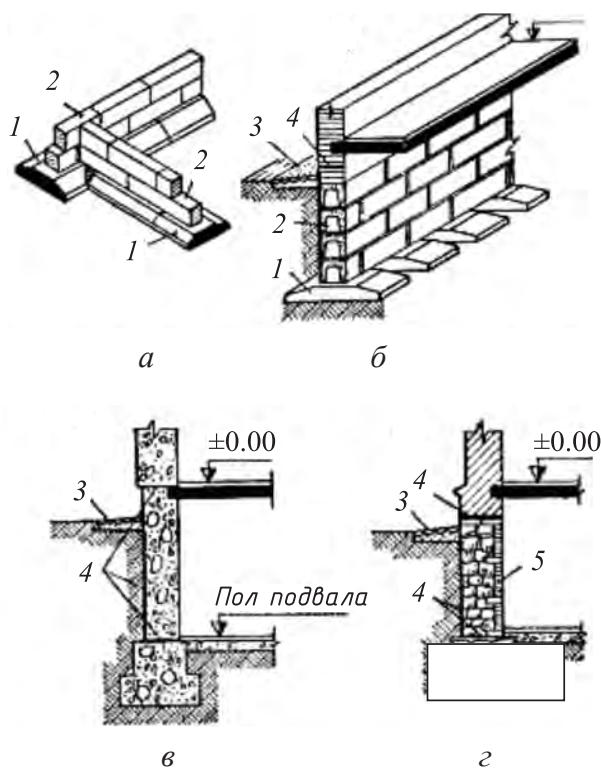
Конструкции ленточных фундаментов: а — сборный; б — то же, прерывистый; в — монолитный фундамент (бутобетонный); г — бутовый фундамент: 1 — фундаментные подушки; 2 — бетонные блоки; 3 — отмостка; 4 — гидроизоляция; 5 — кирпичная облицовка (в полкирпича)
